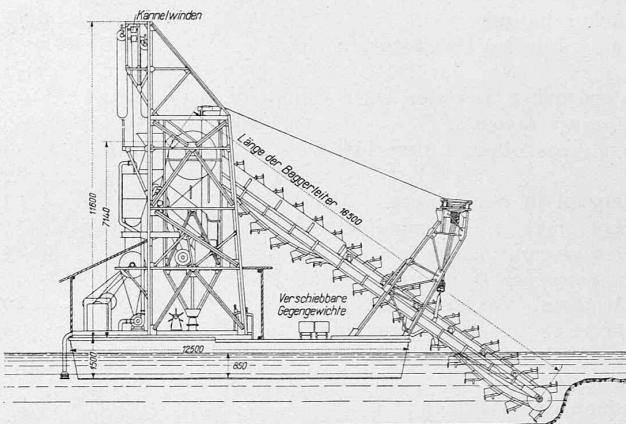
Seitenansicht des Schwimmbaggers. — 1:250.
